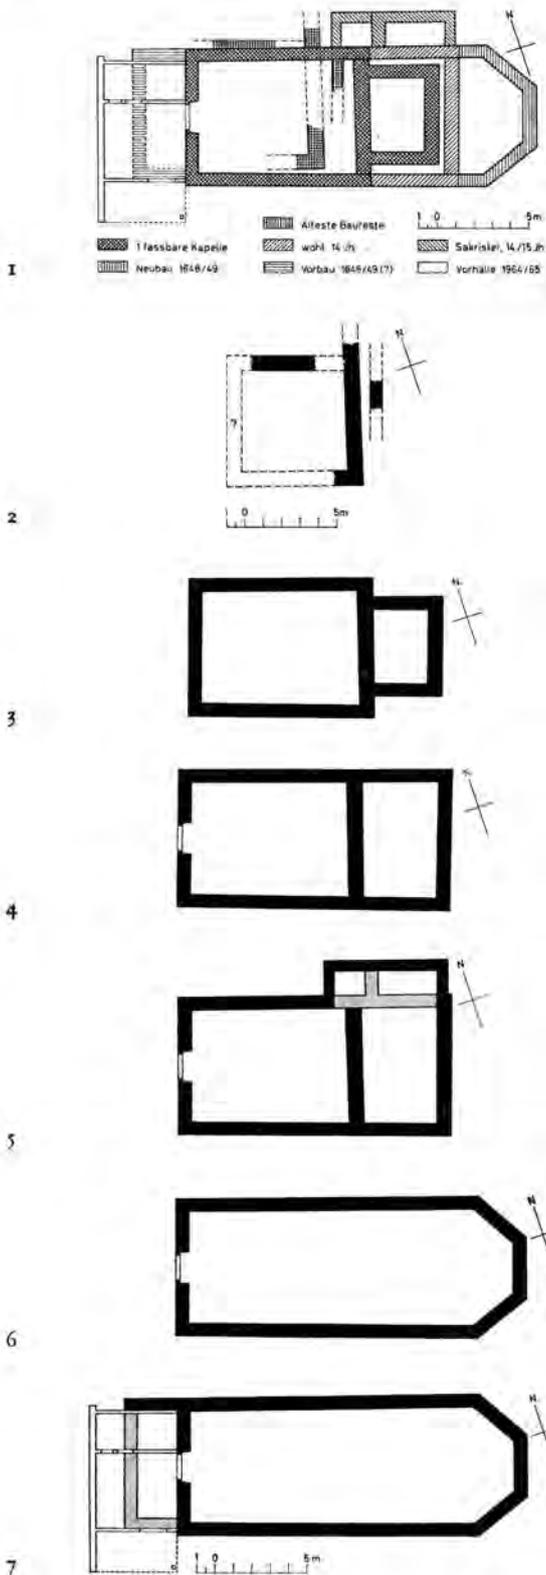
Pfungen ZH, Reformierte Kirche. 1 Bautappenplan. – 2 Reste eines Profanbaus und Westmauer einer frühmittelalterlichen Kapelle. – 3 Erste fassbare Kapelle oder Kirche. – 4 Gotische Kirche, wohl 14. Jh. – 5 Gotische Kirche mit Sakristei-anbauten. – 6 Kirche von 1648/49. – 7 Grundriss der Kirche mit Vorhalle von 1648/49 (?) und heutiger Vorhalle. – 1:400.
